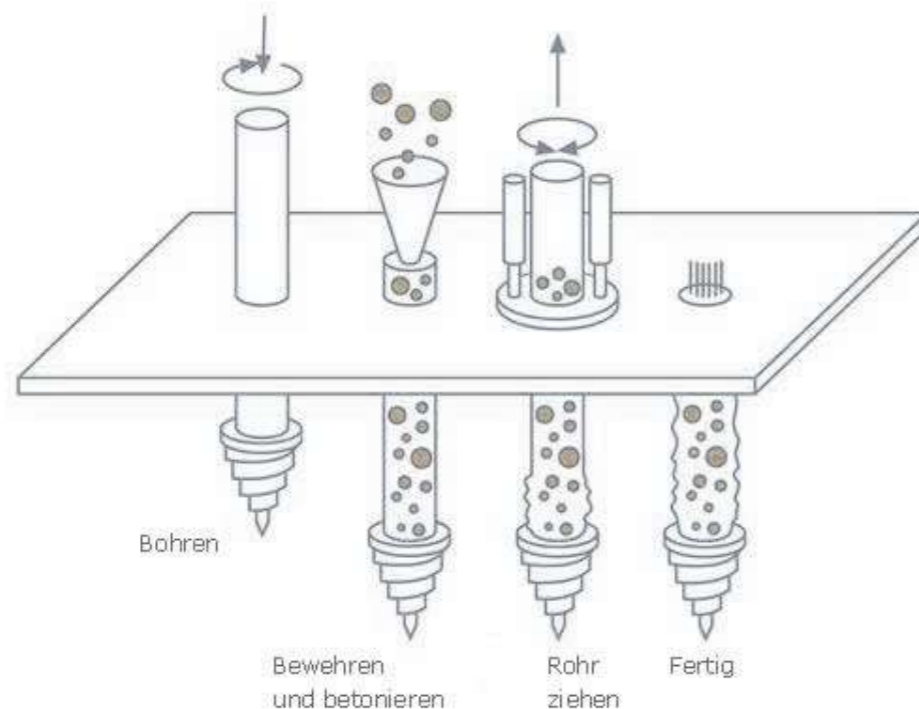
Ortbeton Vollverdrängerbohrpfähle - pfahlkoenig.de
